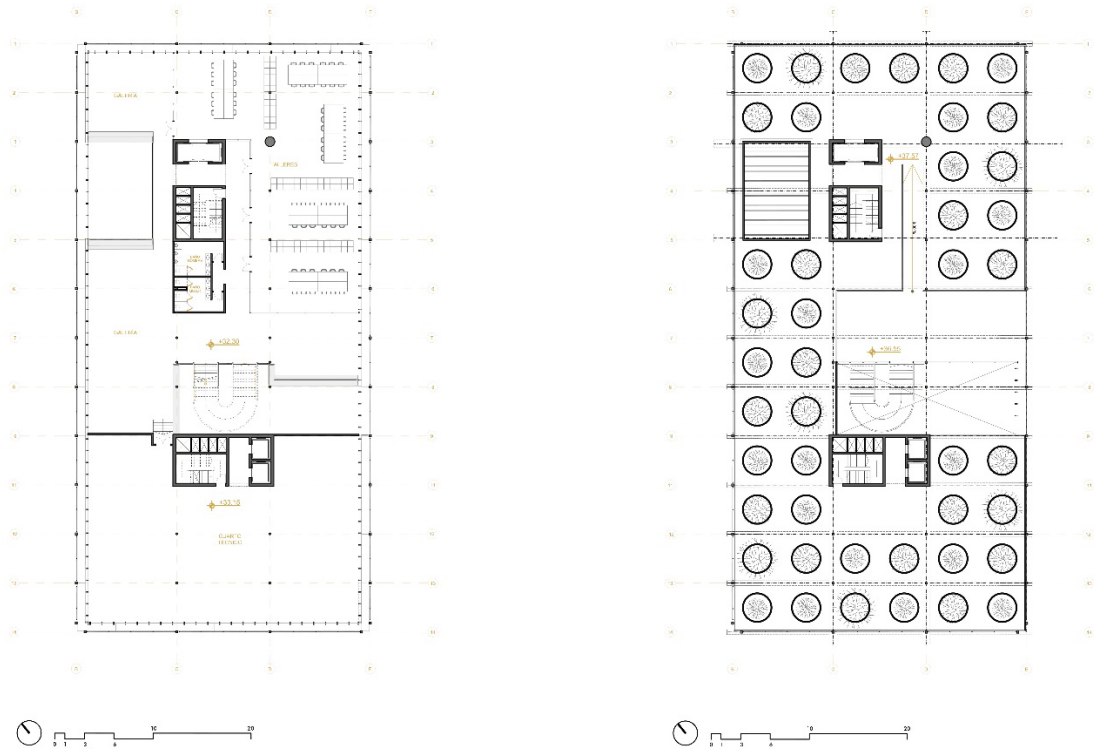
Planta alta 7 y cubierta. Elaboración propia.
